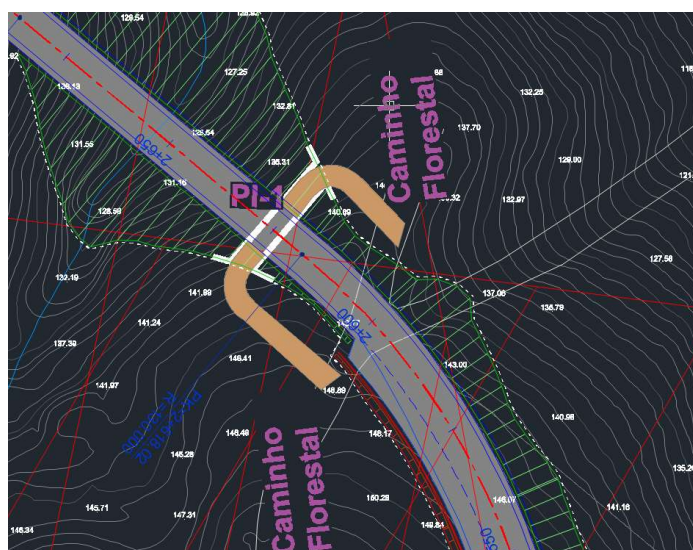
Vista geral da situação proposta de passagem inferior
